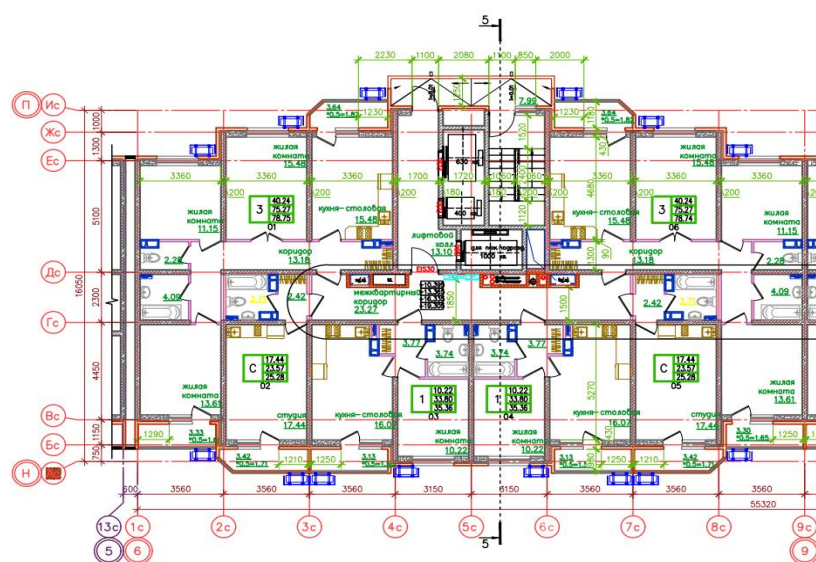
Типовой план 4-7 этажа БС-6 ЖК URAL
